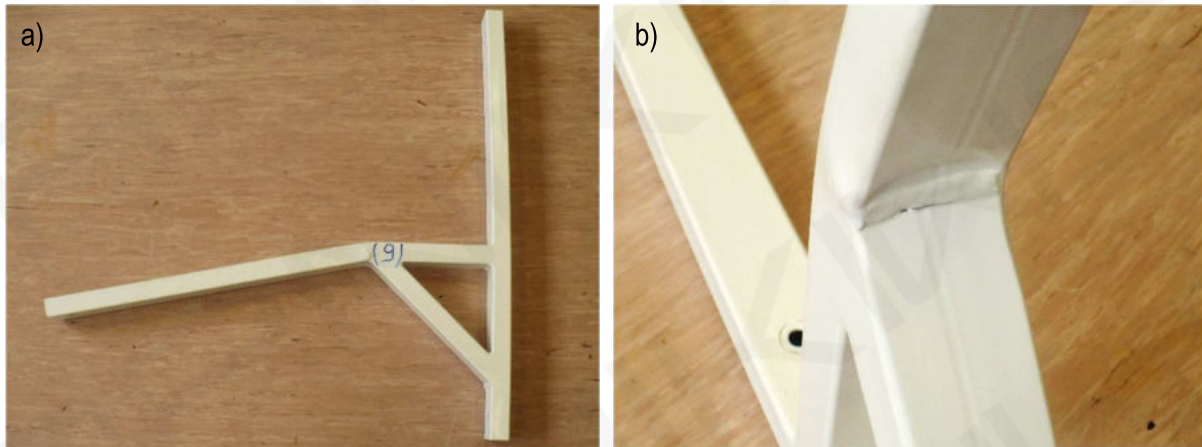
Widok zniszczonego elementu P6: a) widok ogólny, b) miejsce zniszczenia
